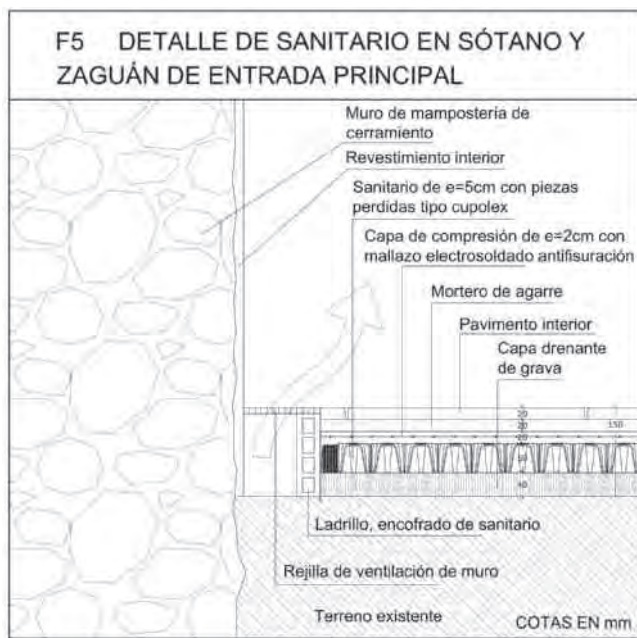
Detalle forjado sanitario en sótano y zaguán.
